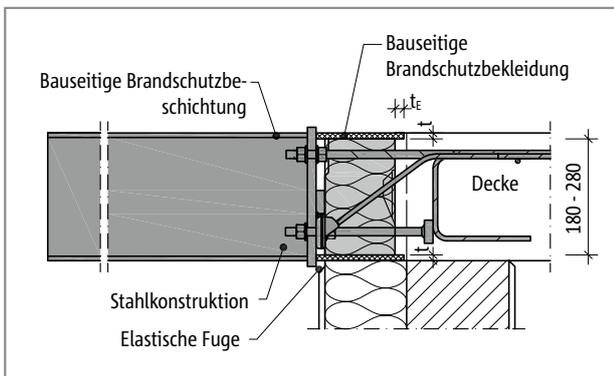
Schöck Isokorb® XT Typ SK: Bauseitige Brandschutzbekleidung für den Isokorb®, brandschutzbeschichtete Stahlkonstruktion; Schnitt
